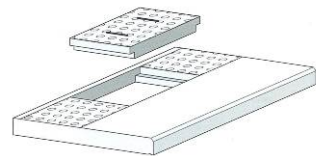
exemple de dalle d'éveil (SNCF Réseaux)
